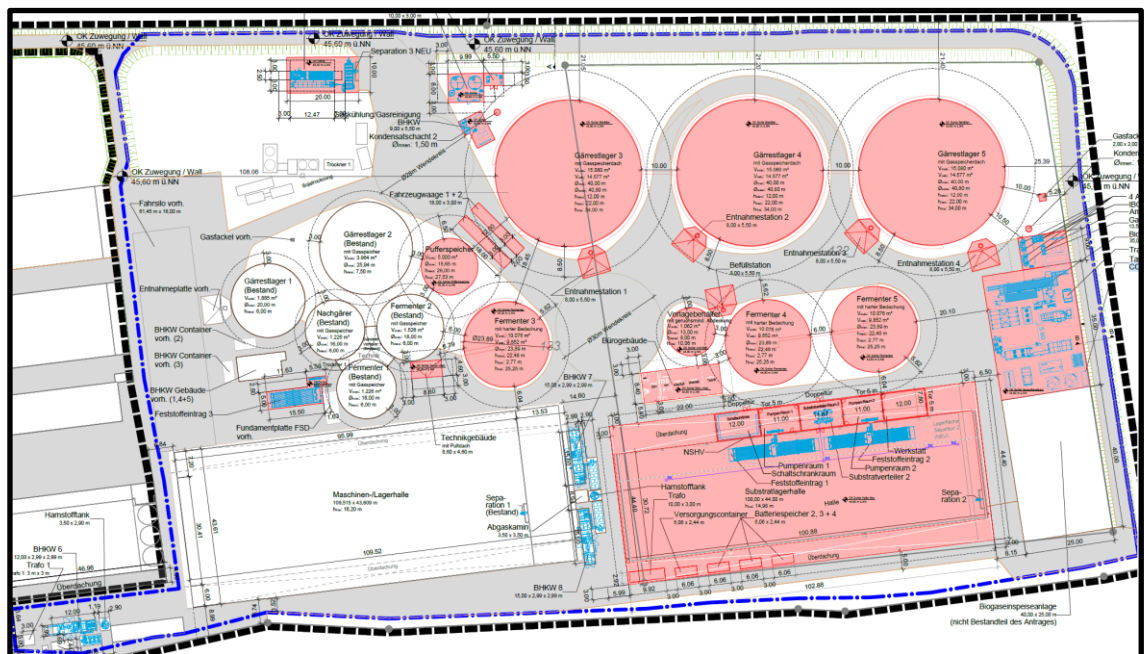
Lageplan - Biogasanlage Gronau; M 1:500; Zeichn.-Nr.: Lageplan\_Gronau\_DS\_260226.dwg; Ersteller: Bioconstruct; Stand: 26.02.2026
